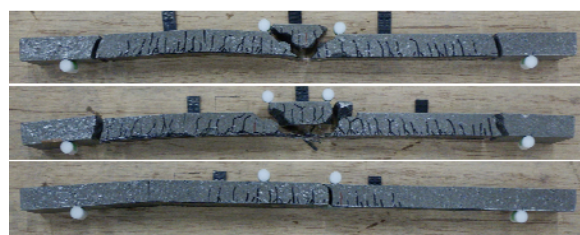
载荷試験後の供試体状況 (はり高さ 40mm)
